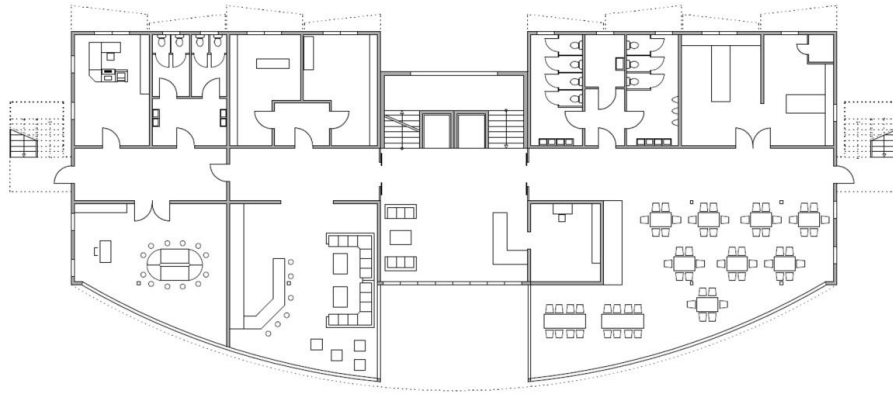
Grundriss EG Eigenentwurf Hotelgebäude
